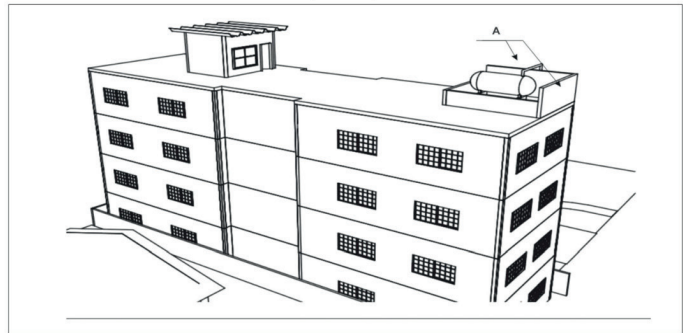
C – Instalação de recipientes em teto e lajes de cobertura de edificações (informativo).
